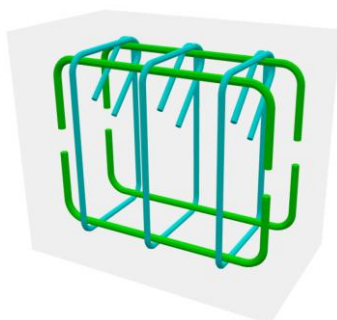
Illustration tridimensionnelle d'un ferrailage d'asselet (hauteur < 35 cm)
